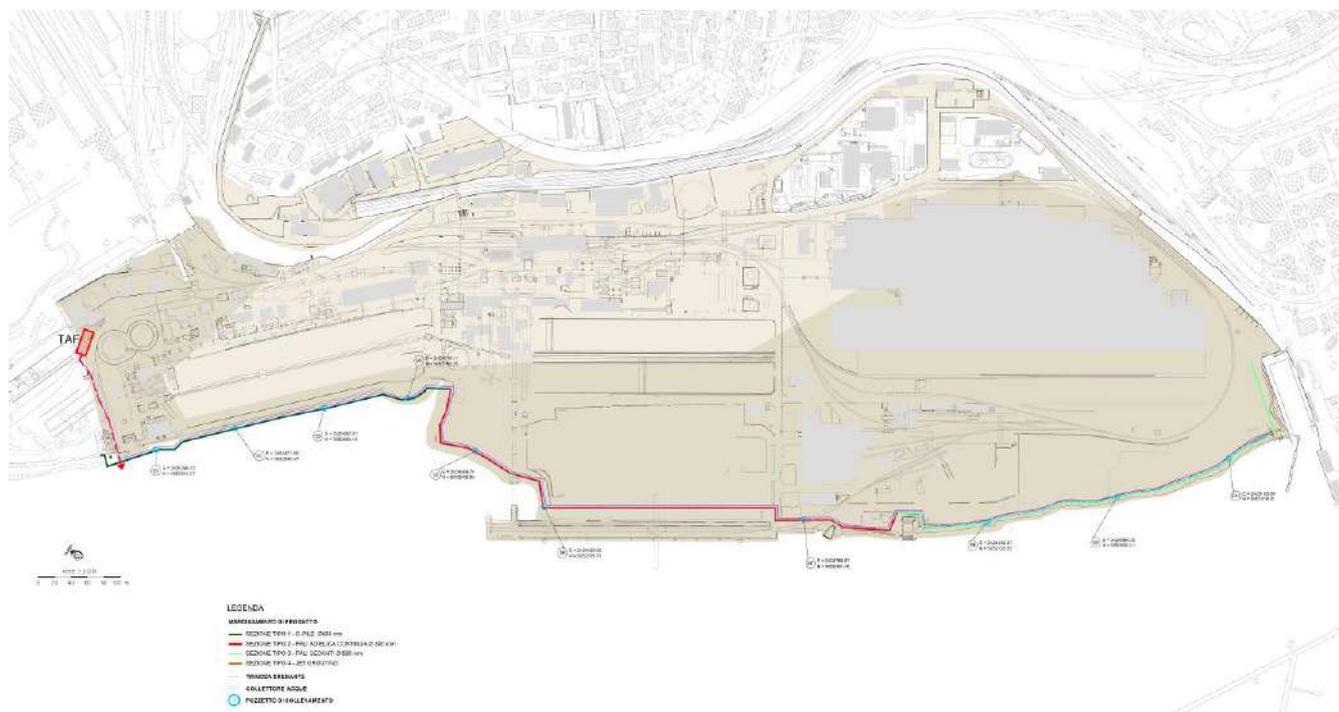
dettaglio della tavola BO-PS0410 – trincea drenante di progetto
